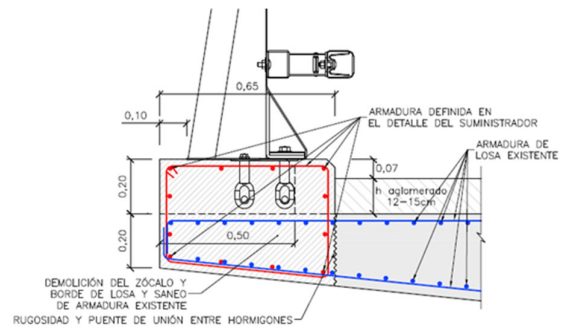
Detalle de movilización de torsión del zunchos sin refuerzo en banda lateral.
